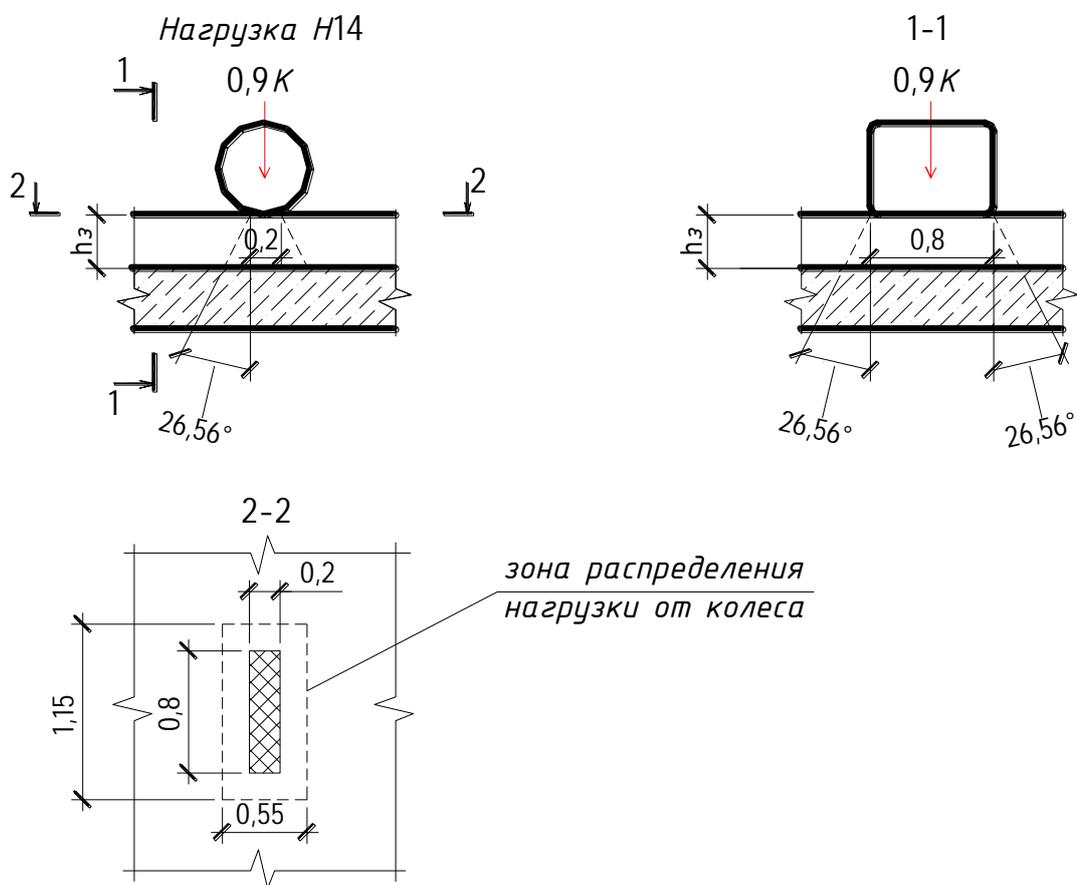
Схема к определению вертикального расчетного давления грунта от транспортной нагрузки N14
